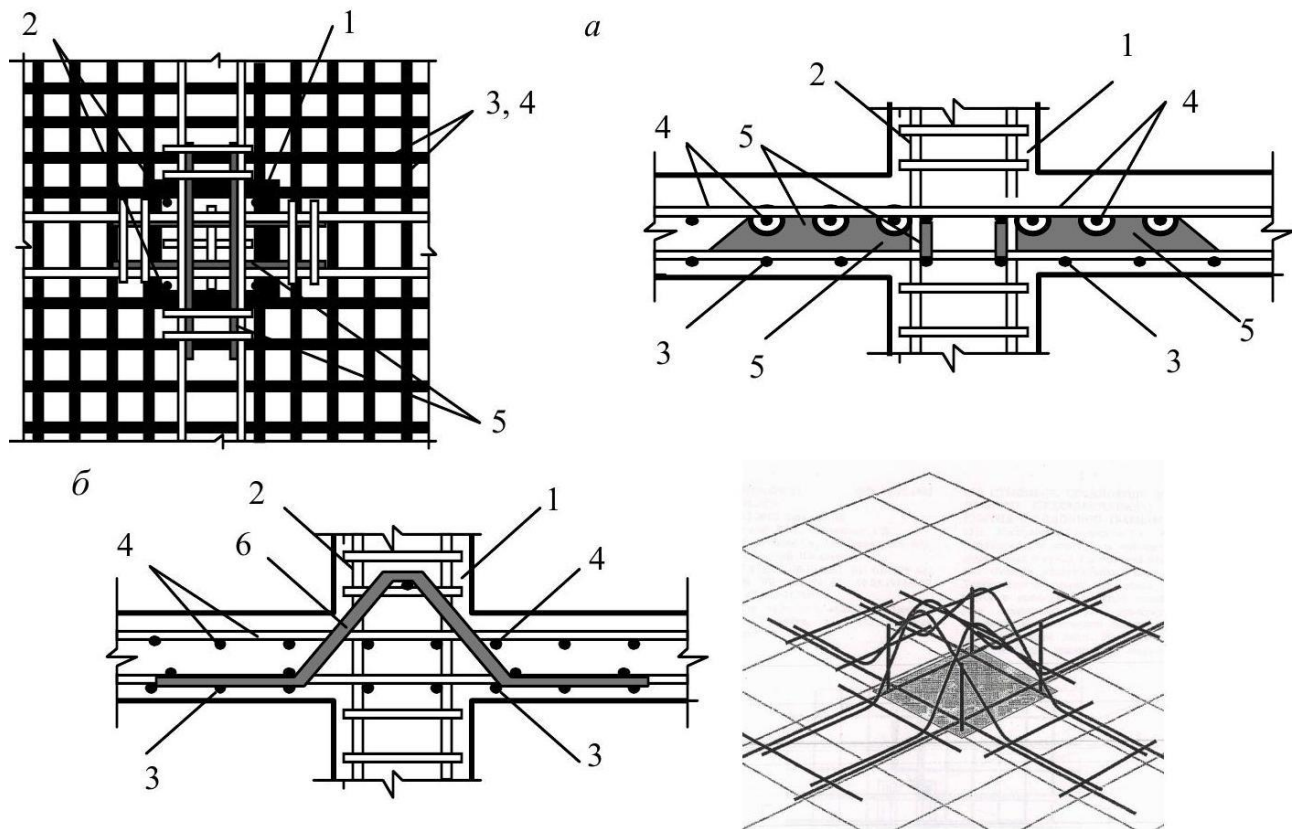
Схема стикового з'єднання безбалковими залізобетонного перекриття:
